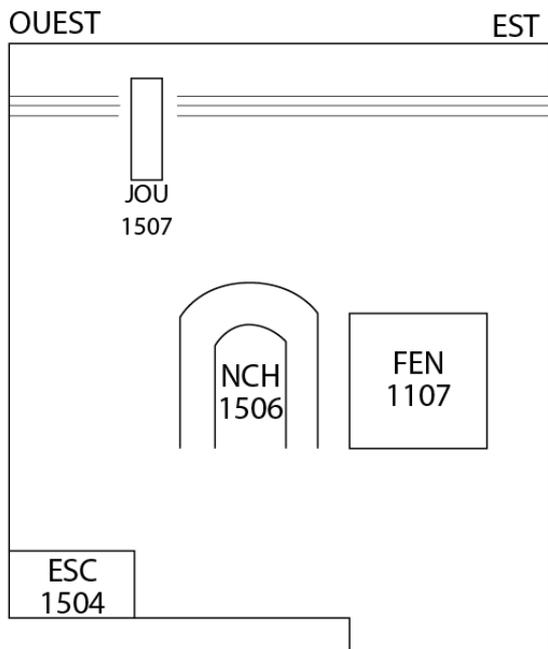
Murs est (1402) de la pièce de l'escalier au rez-de-chaussée (PCE 15), croquis.
